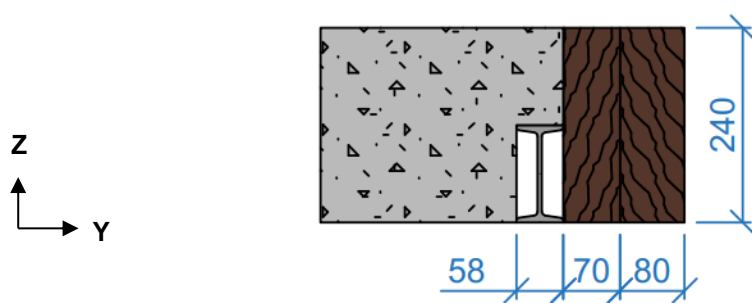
Coupe de la poutre de l'ancienne trémie (8)
